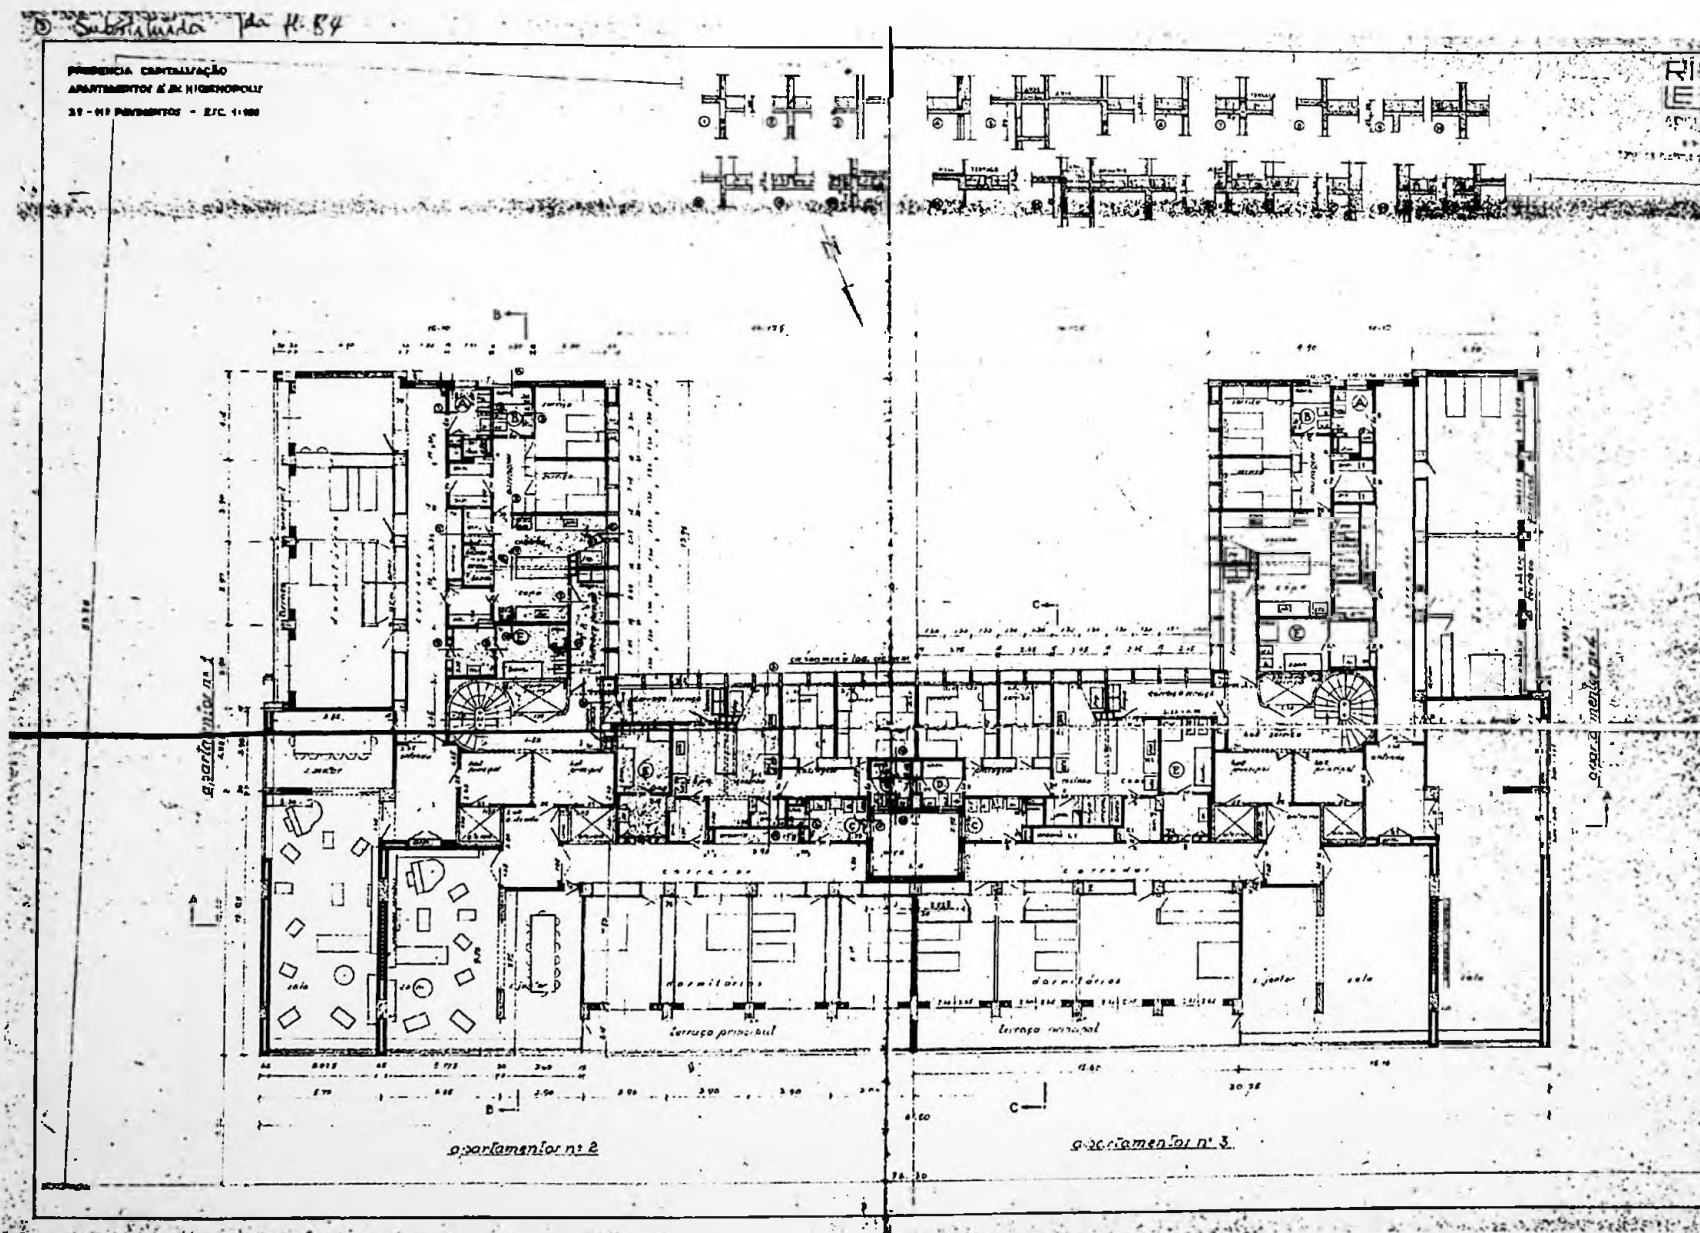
Planta 3º ao 11º pavimentos (08/09/1944)
